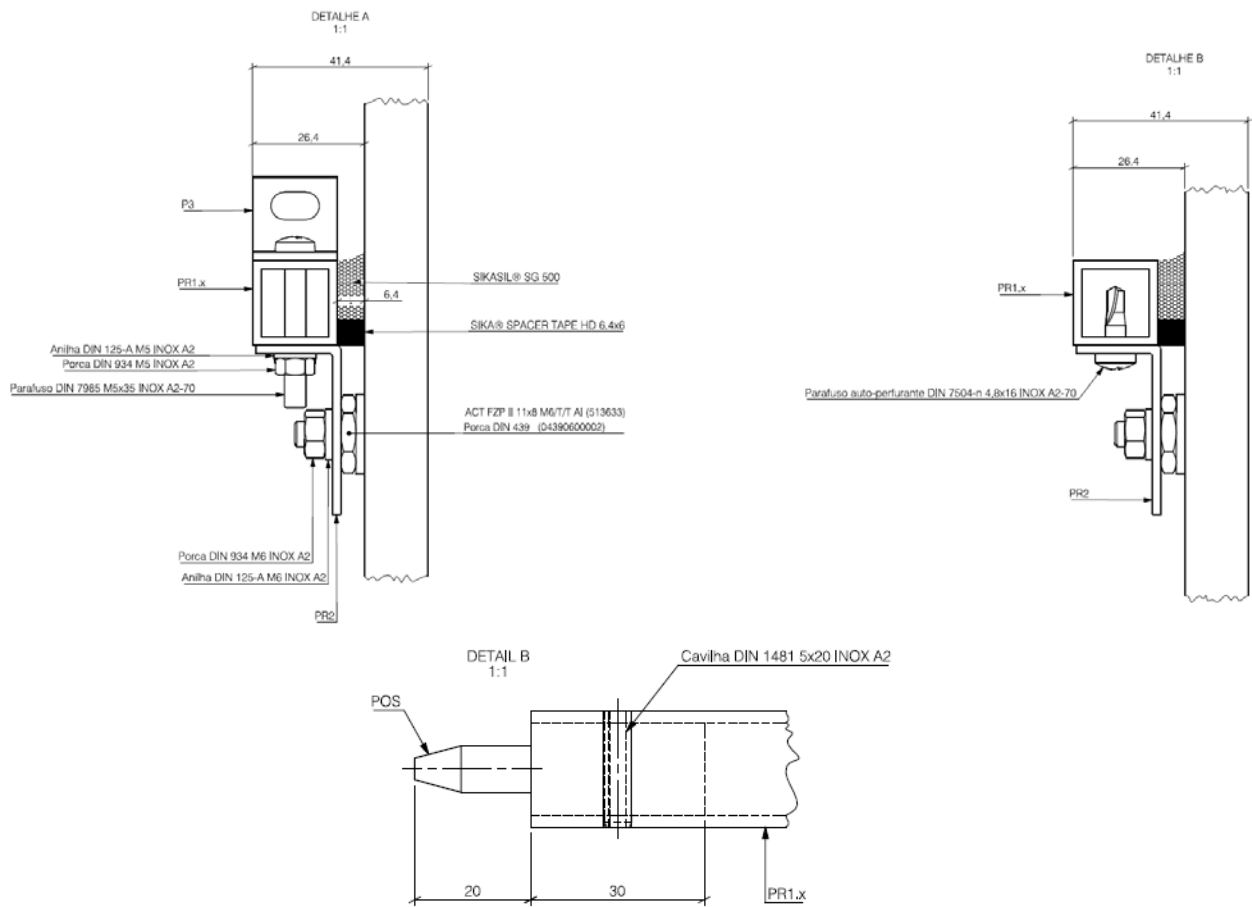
Pormenores construtivos do sistema do sistema de fixação do ladrilho cerâmico.
